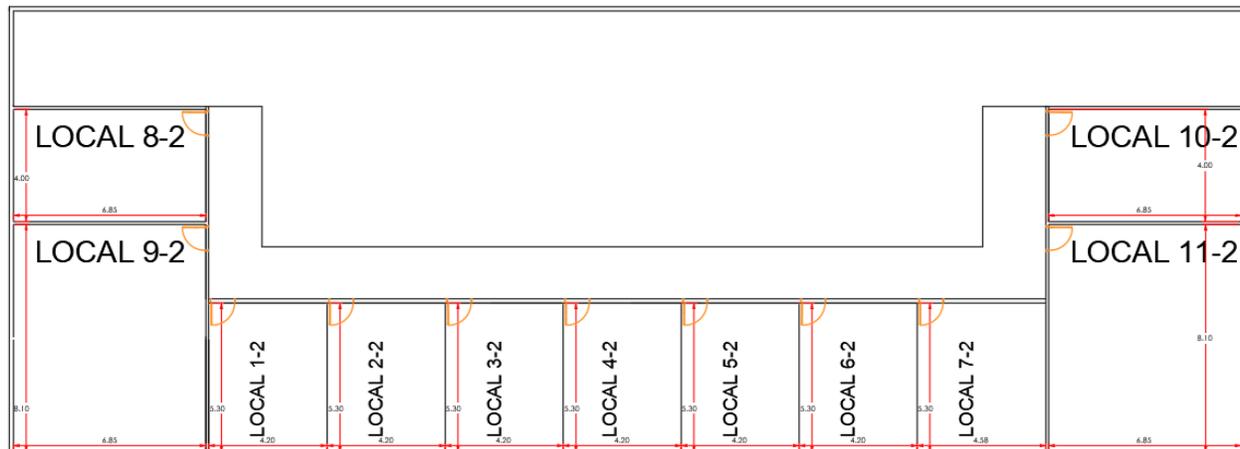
Vista en planta de primer piso, Plano Arquitectónico.
